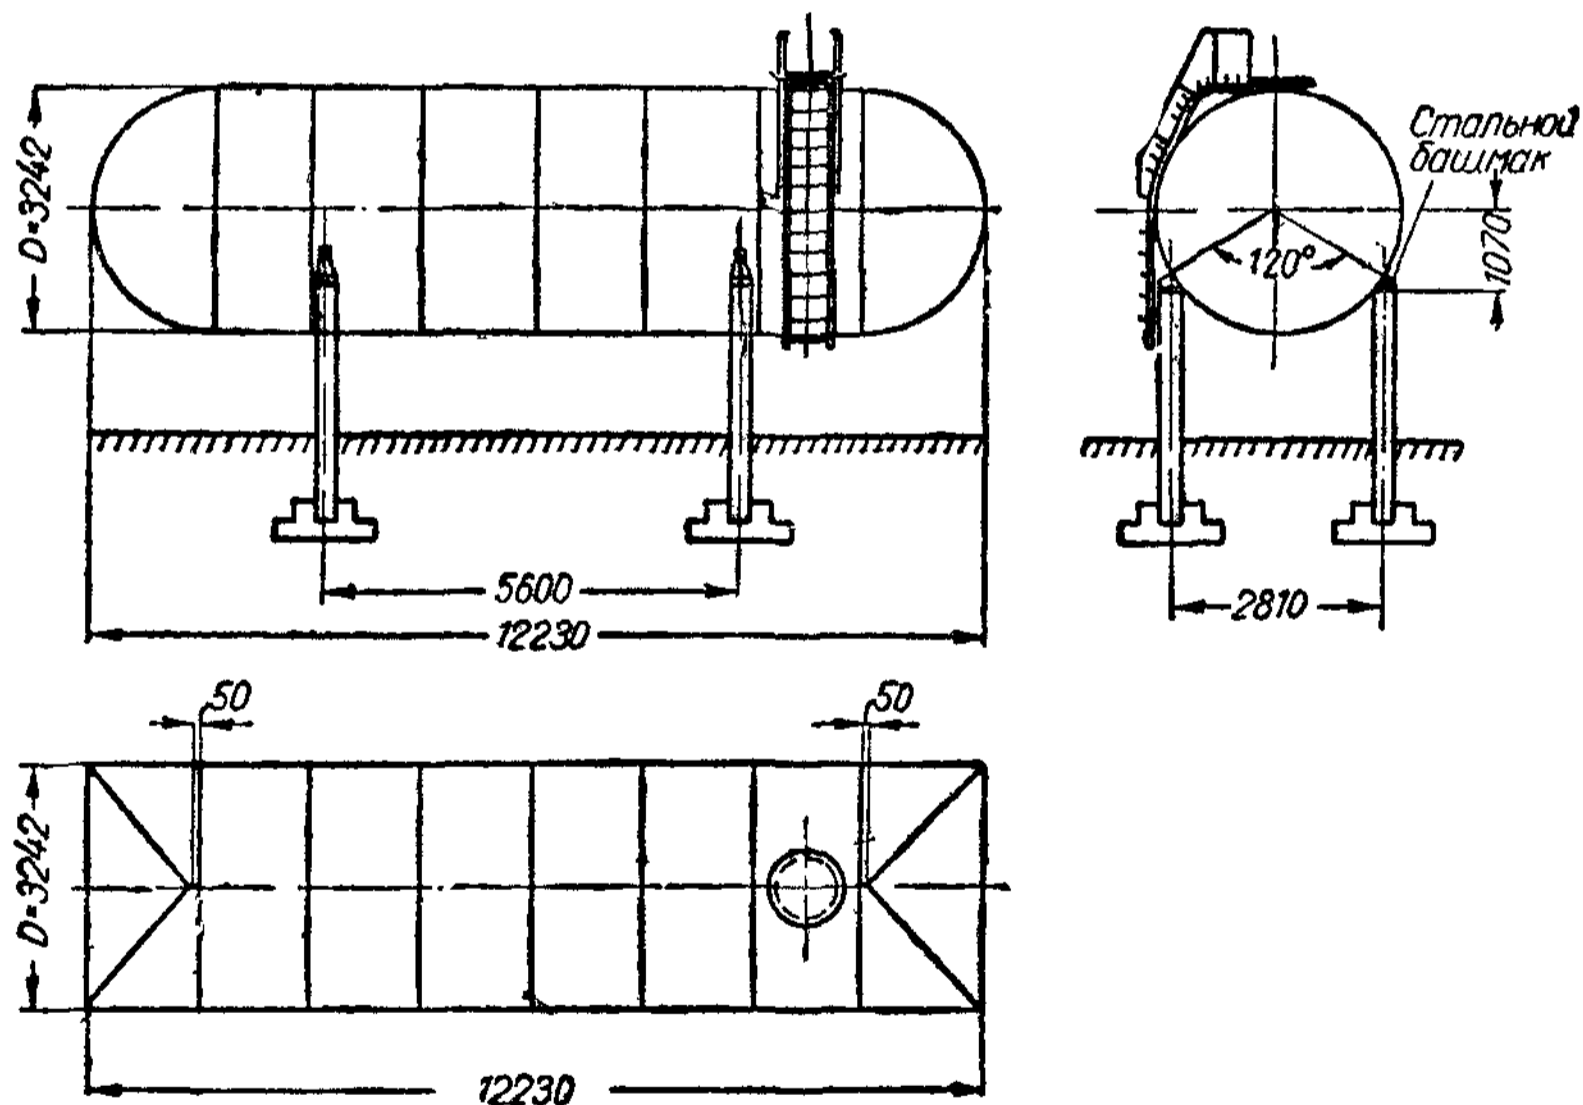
Горизонтальный резервуар емкостью 100 м^3 с цилиндрическими днищами на стоечных опорах из сборных железобетонных стоек и фундаментов
